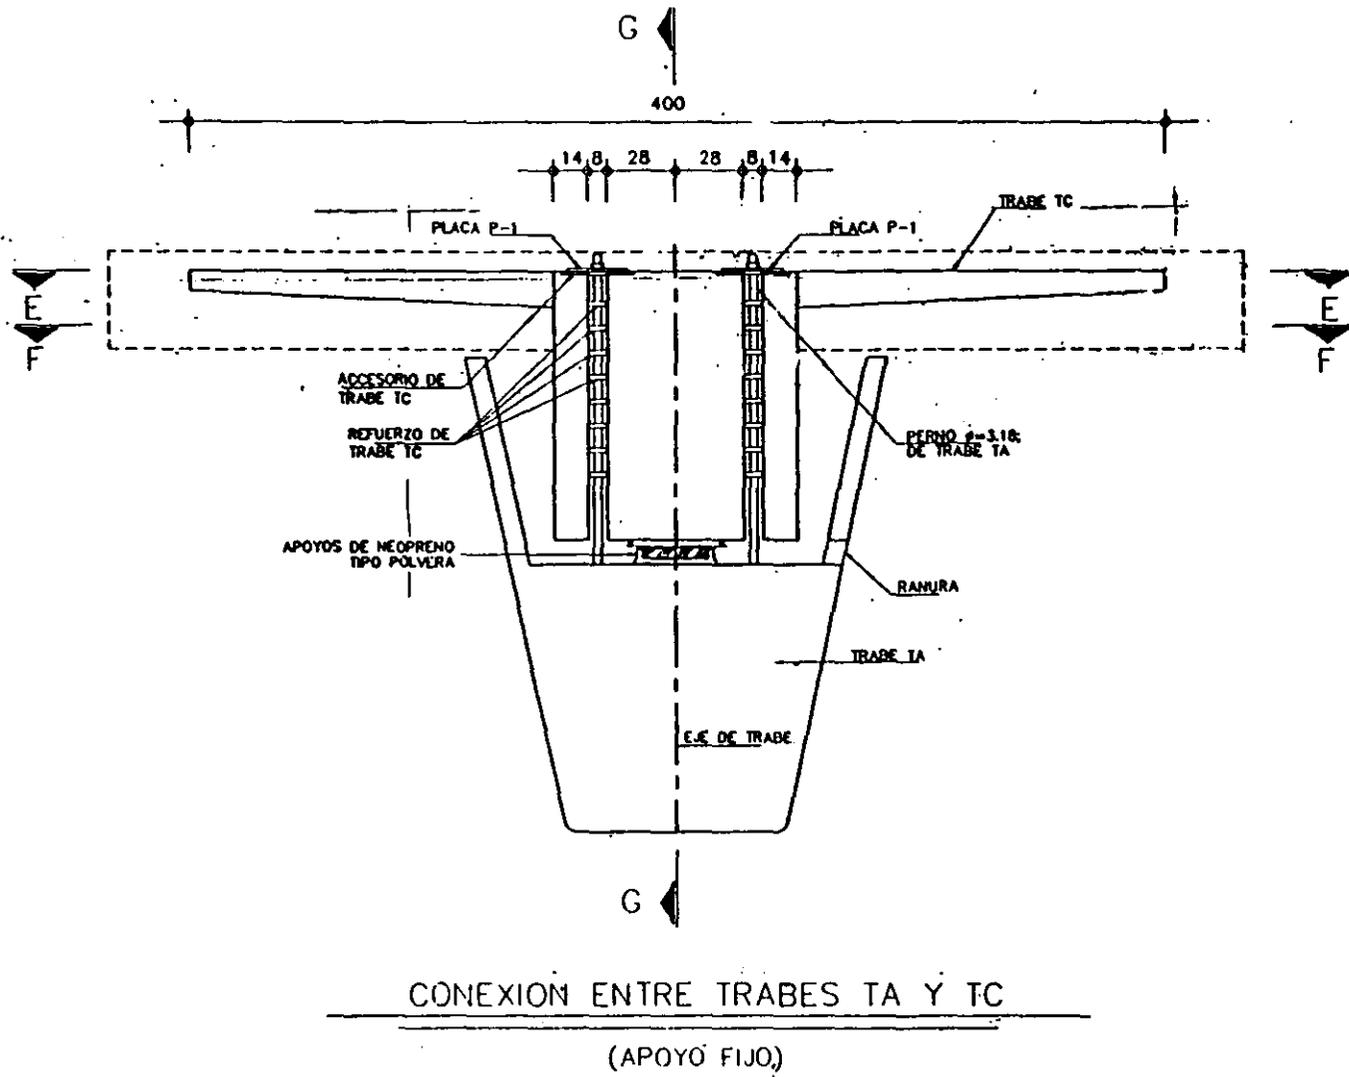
A(1). Unión Entre Trabe de Apoyo y Trabe de cierre (vista transversal).
